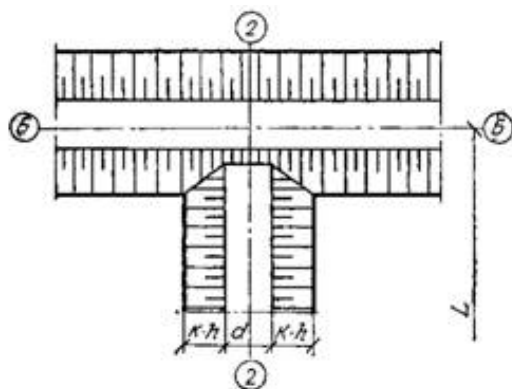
Схема образования углового сопряжения со смещенными осями плана относительно осей симметрии сечений
